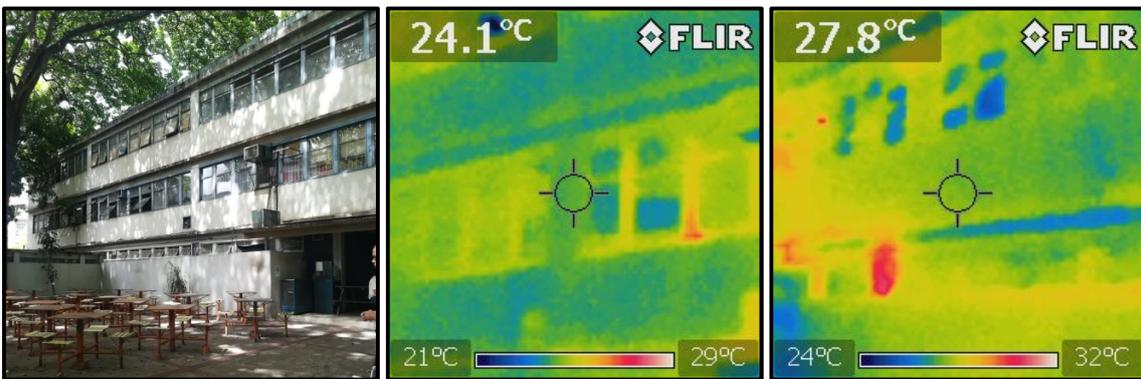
Fachada interna, edificio de ventanas de vidrio.
